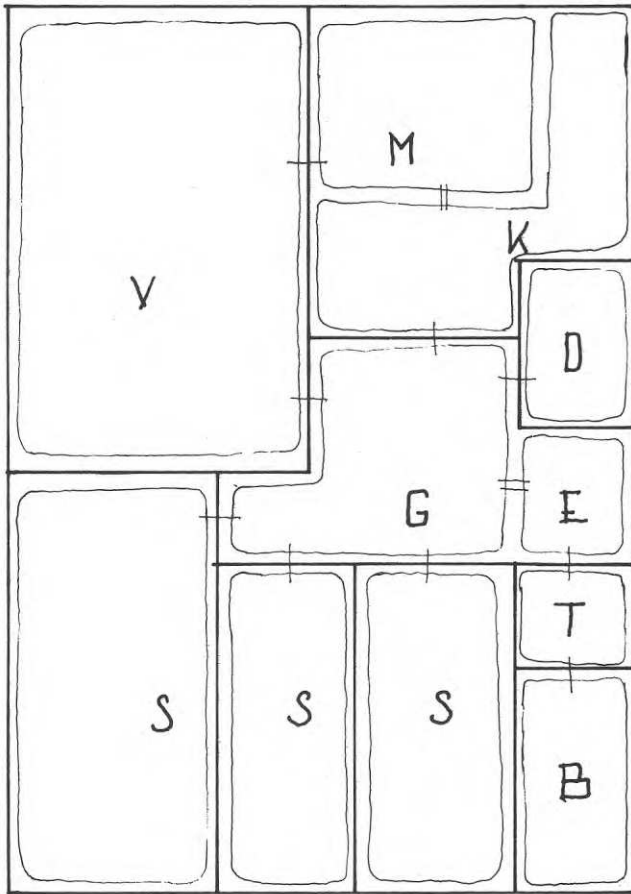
Rumssambanden i en traditionell plan i 90 m²-lägenheterna.
